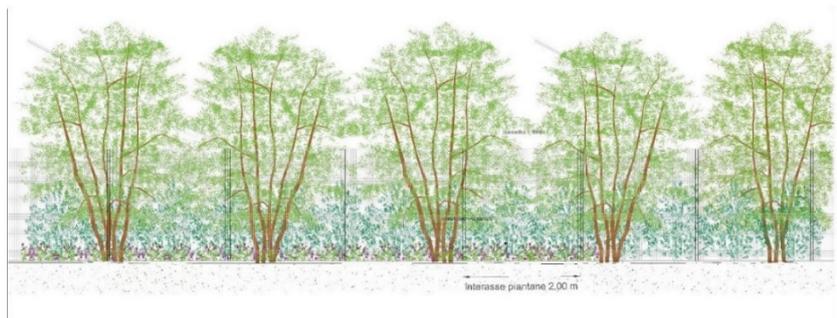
Prospetto recinzione perimetrale con mitigazione
